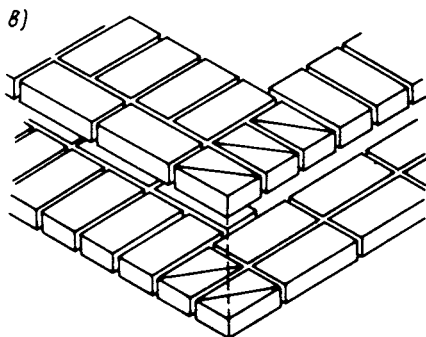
Завершение кладки стены толщиной 38 см (а) и 52 см (б); перевязка угла стены (в)
